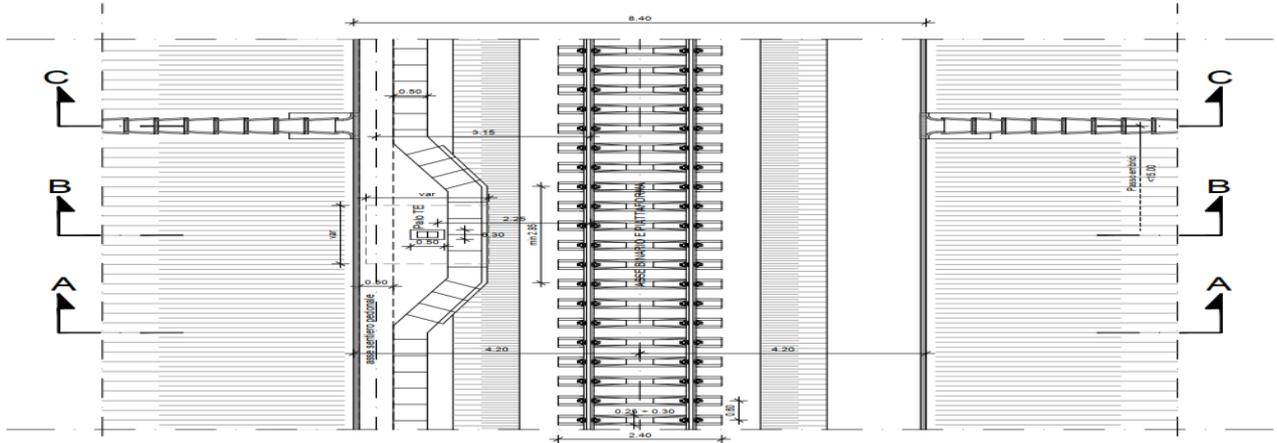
Stralcio planimetrico con sezione tipo ferroviaria in rilevato a singolo binario in rettilo
